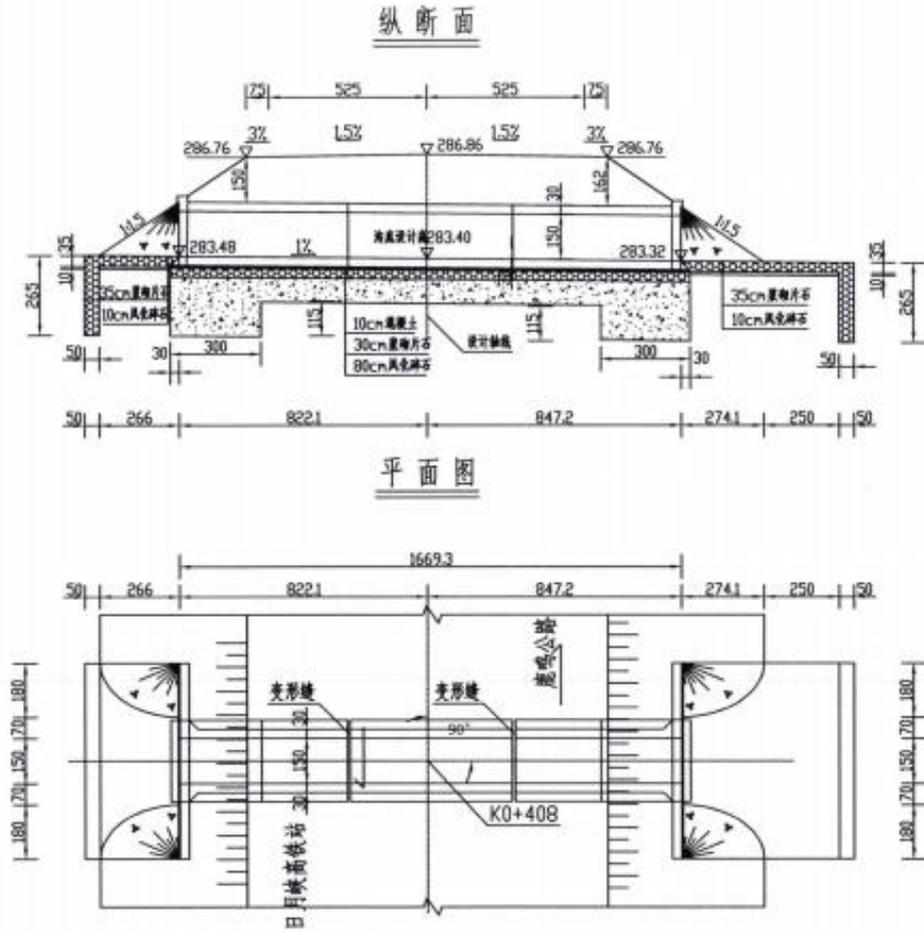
1-1.5 × 1.5 钢筋混凝土箱涵构造图
